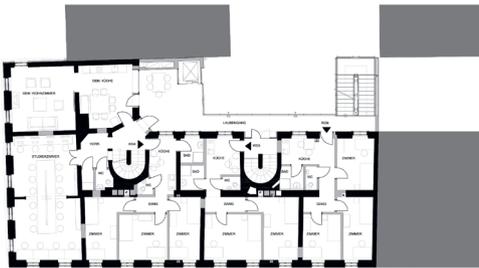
| VinziRast. Grundriss 1. Obergeschoß
